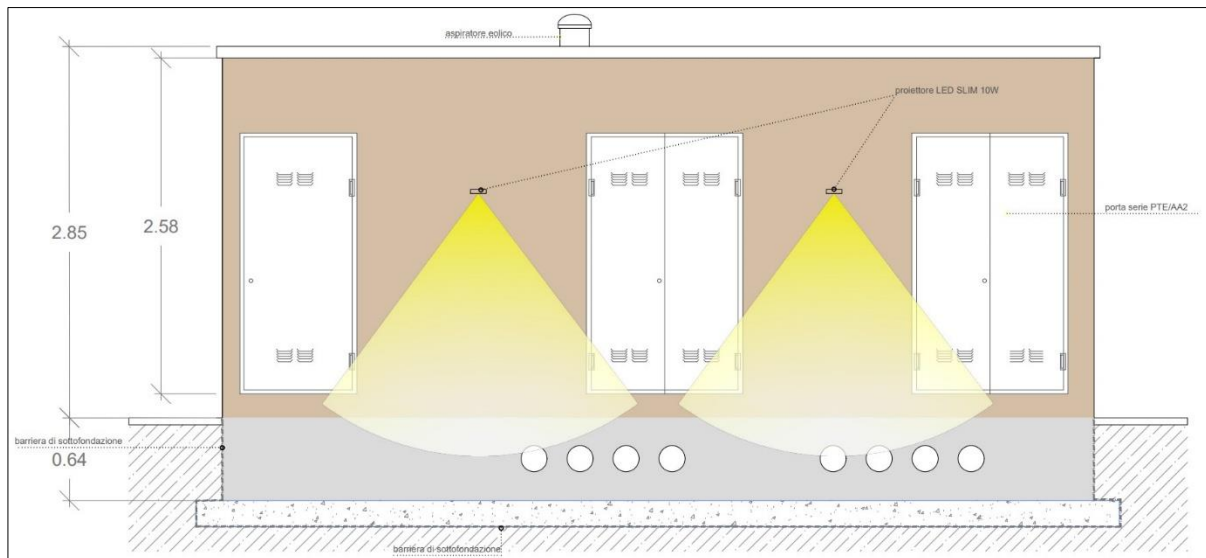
Prospetto struttura di fondazione cabina utente di consegna
